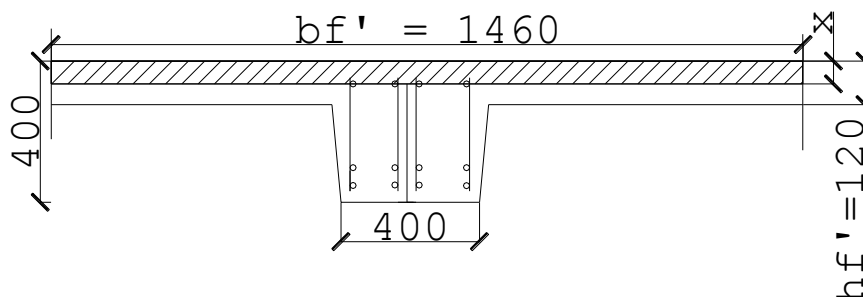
Расчетное поперечное сечение продольных ребер плиты покрытия
